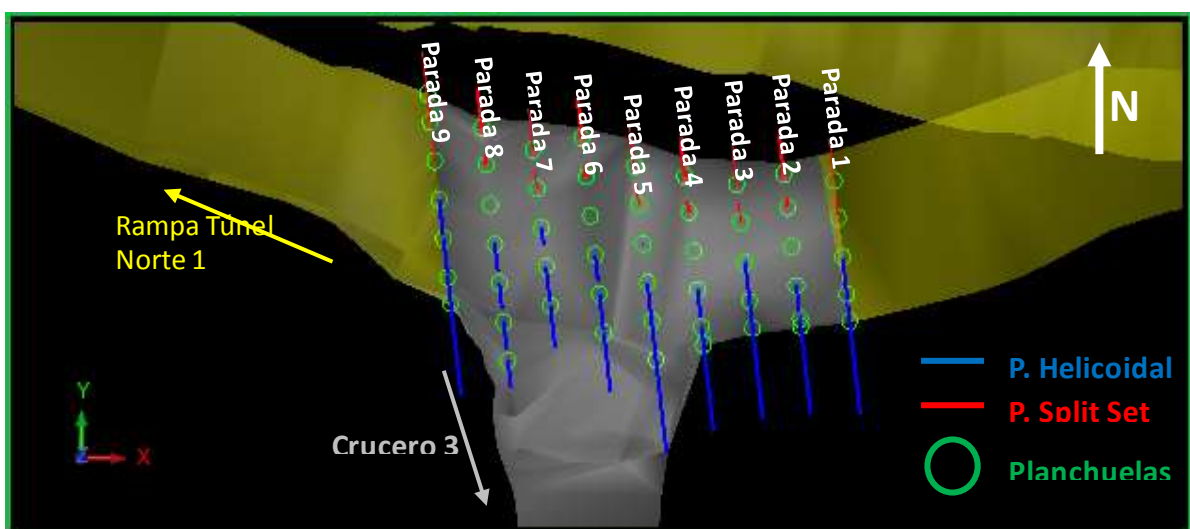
Vistas en Planta de la distribución de los abanicos o paradas
